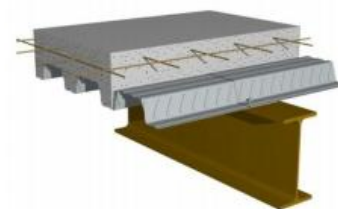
Les planchers collaborant /source : https://ds.arcelormittal.com/construction/france/produits/Plancher_acier
